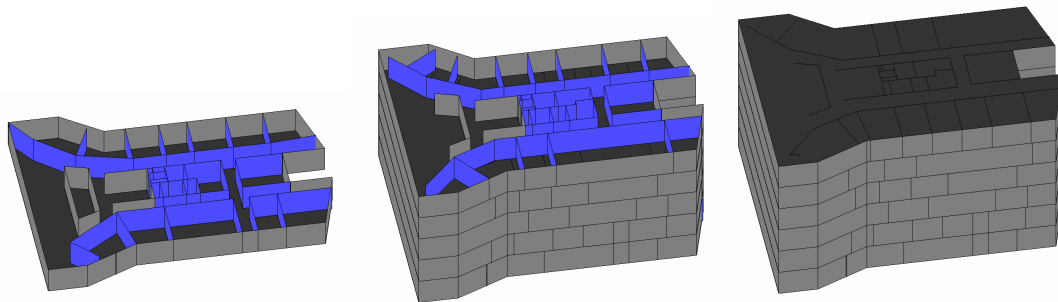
Exemple de construction 3D simplifiée par extrusion de plan
